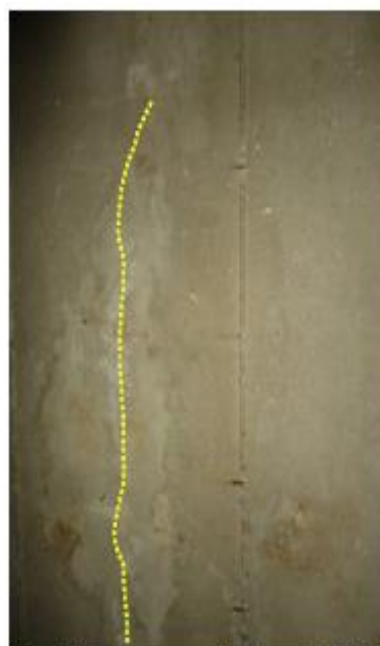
Fissura com abertura de 1,0 mm na laje.
